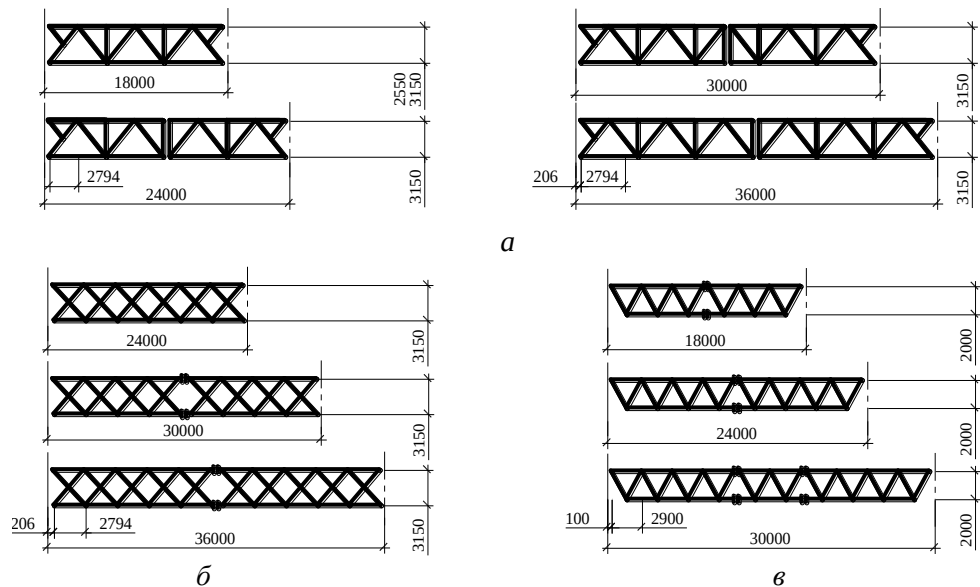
Схеми типових ферм з паралельними поясами:
